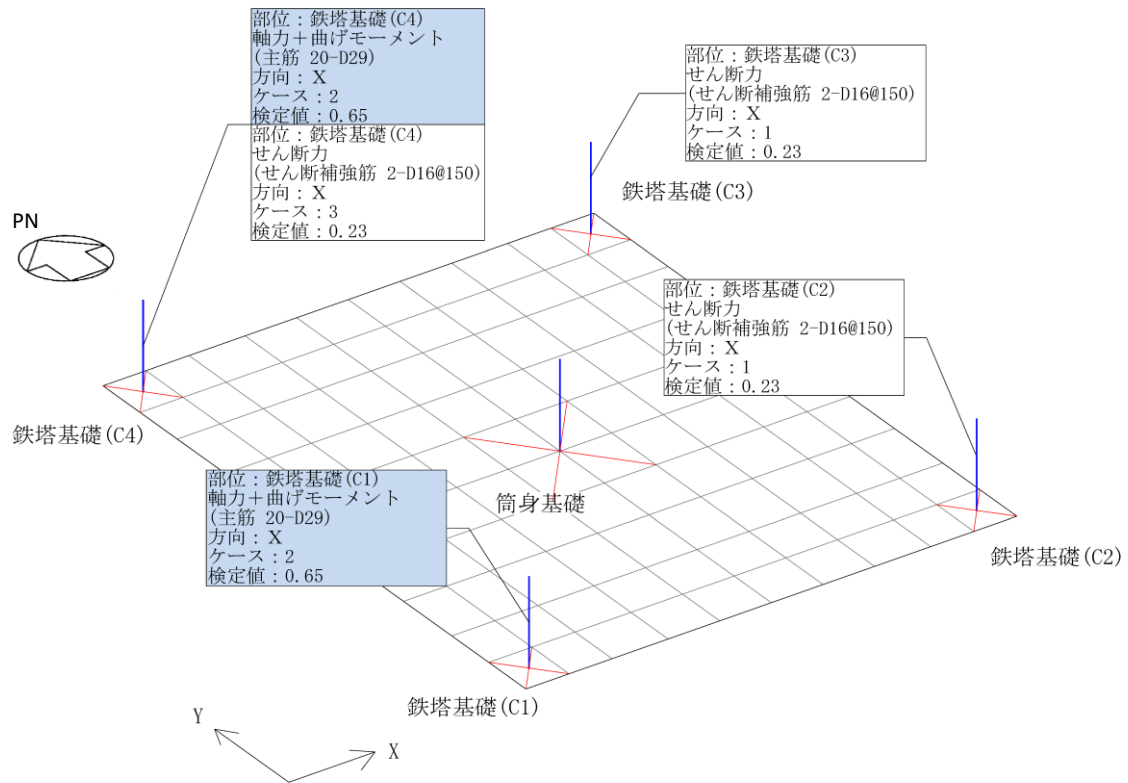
鉄塔基礎及び筒身基礎の概略配筋図
